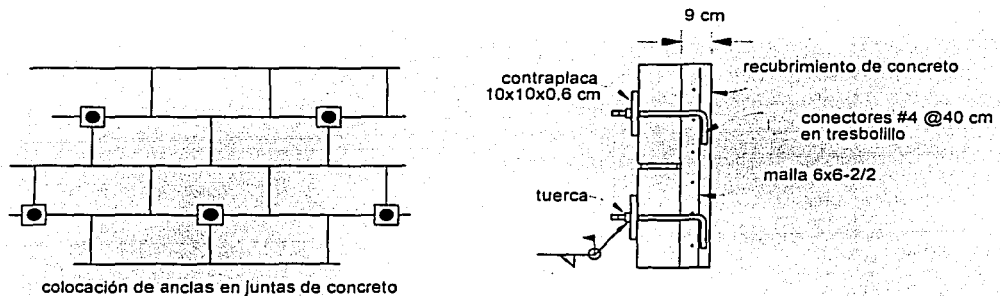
Detalles del refuerzo del proyecto no. 2
